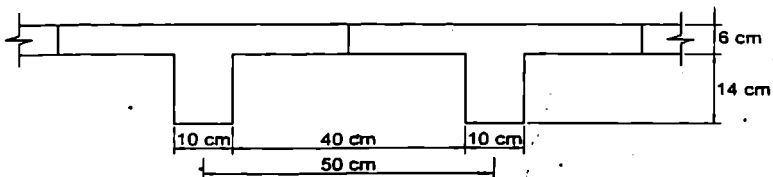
Seção transversal adotada para a laje do exemplo.
